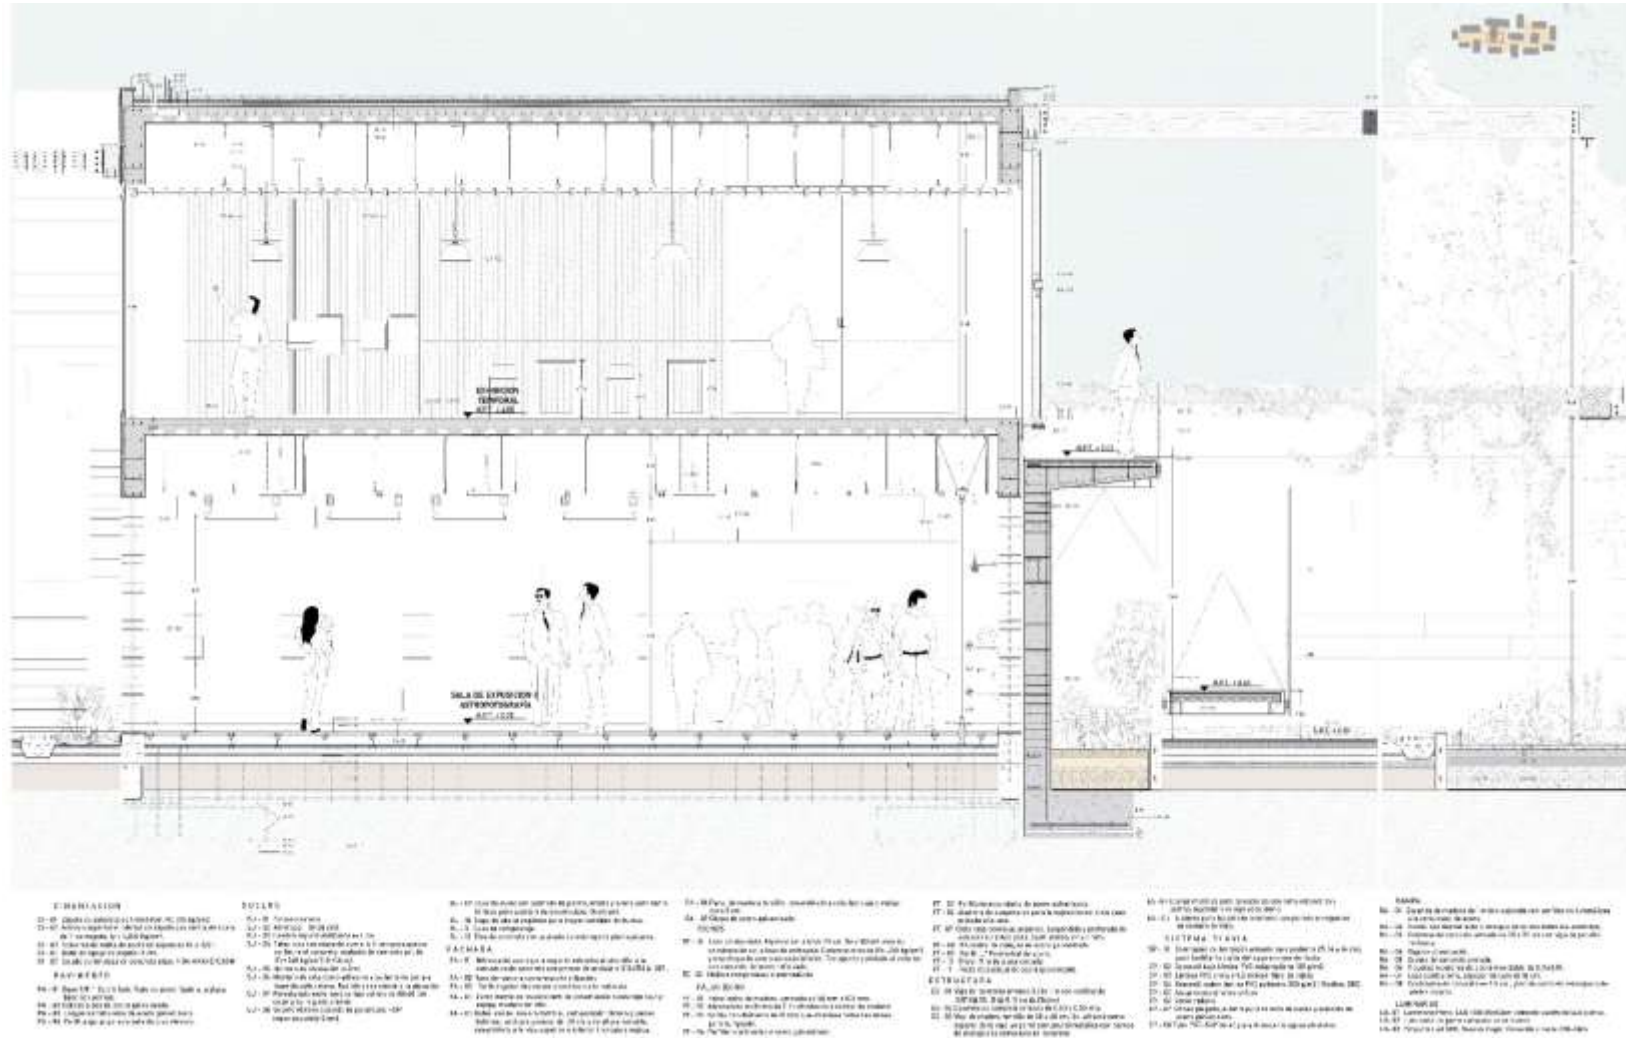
Corte constructivo B-B. Fuente elaboración propia.
